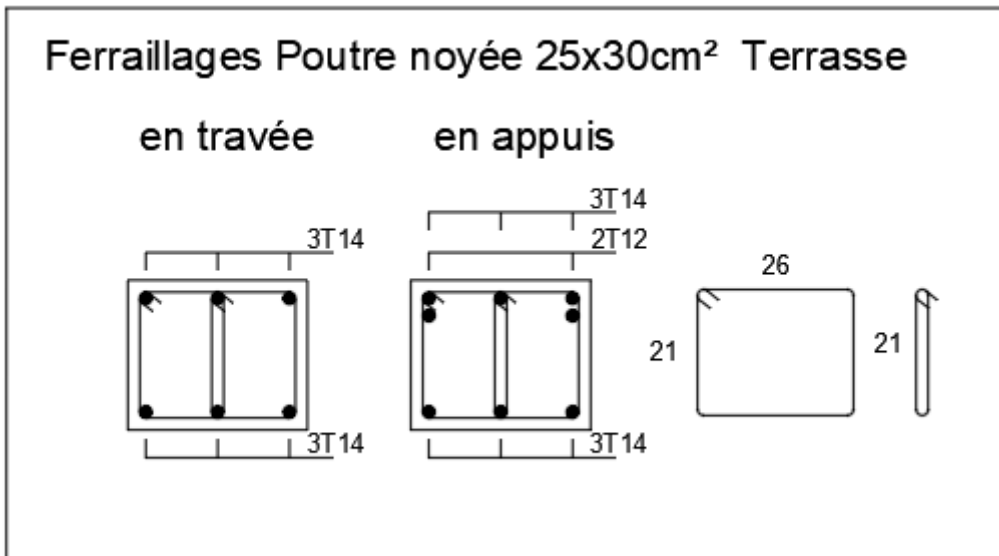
Schéma de Ferrailages poutre noyée terrasse
